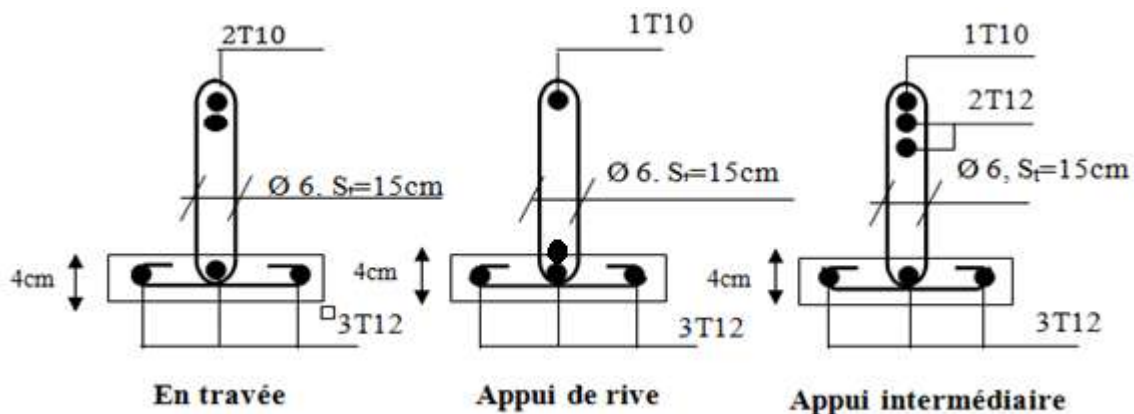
Schéma de ferrailage des poutrelles terrasse
